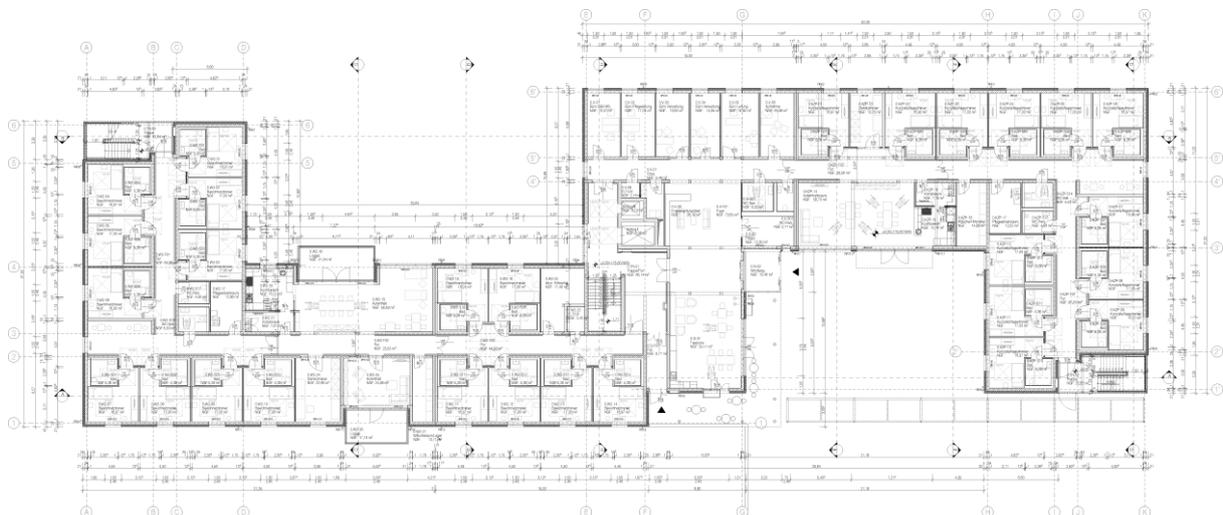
Grundriss EG _ Seniorenzentrum_HWR
